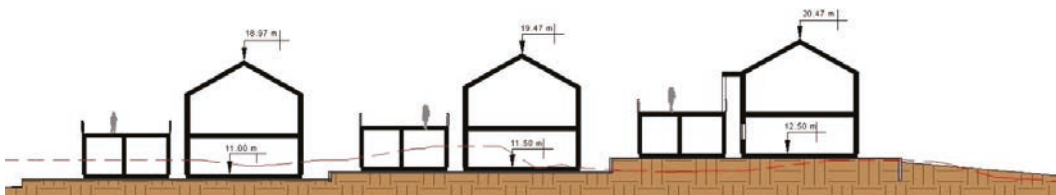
Snitt D, gjennom bolig 1 til 6
